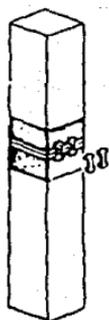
PILOTE TIPO CON PLACAS DE CONEXION
